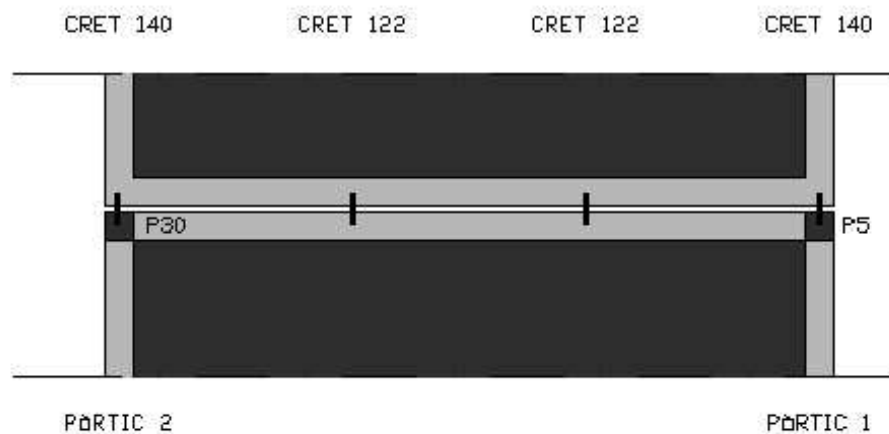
Disposició de passadors tipus Cret Goujon als sostres de la Planta Baixa i la Planta Primera.
